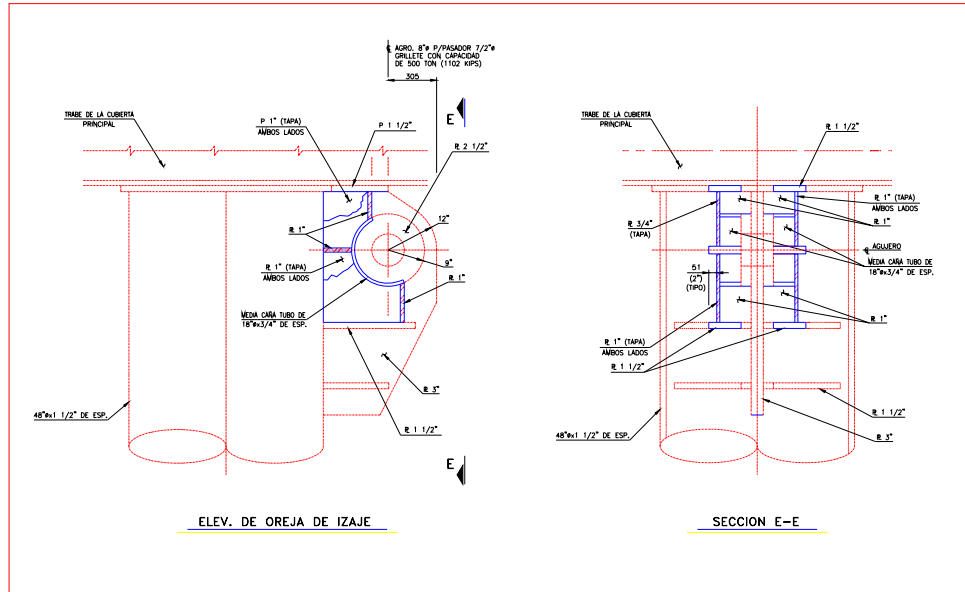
REFORZAMIENTO DE LAS OREJAS DE IZAJE
